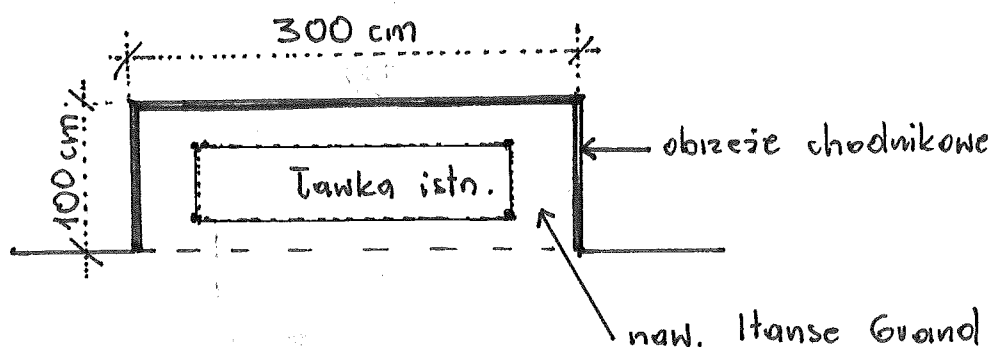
PLANSZA – PROJEKT PIELĘGNACJI
